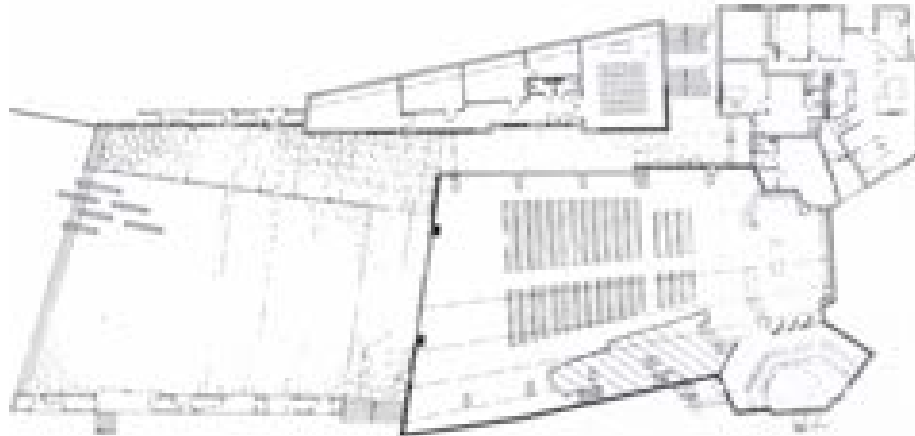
La planimetria del progetto realizzato, 1978⁶³
